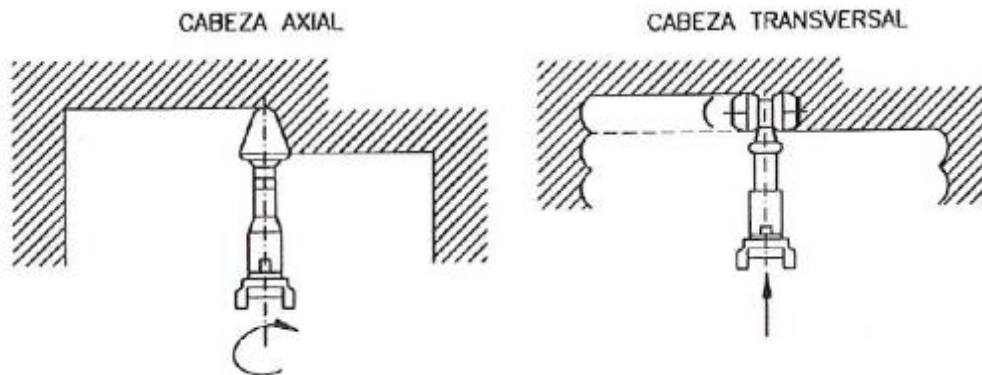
78: Perfil de excavación del sistema axial y transversal. (Carlos López Jimeno et al., 2012).
